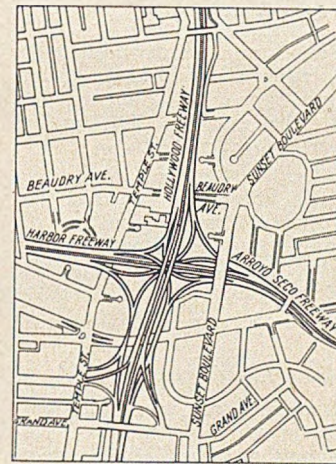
Lageplan der Kreuzung in 4 Ebenen.
